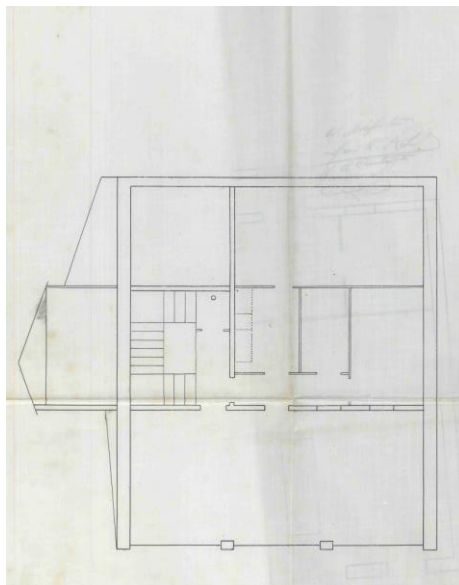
Planos originales archivo municipal de Vilagarcía de Arousa.
